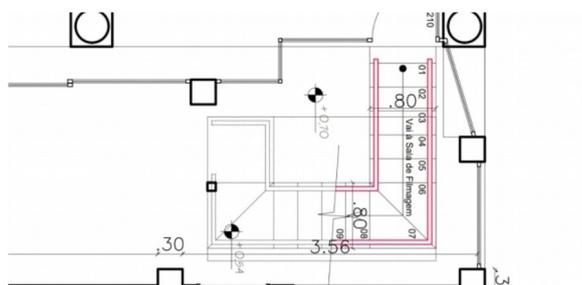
RECORTE DA PLANTA DA LOCALIZAÇÃO DA ESCADA QUE NECESSITA DO PATAMAR
